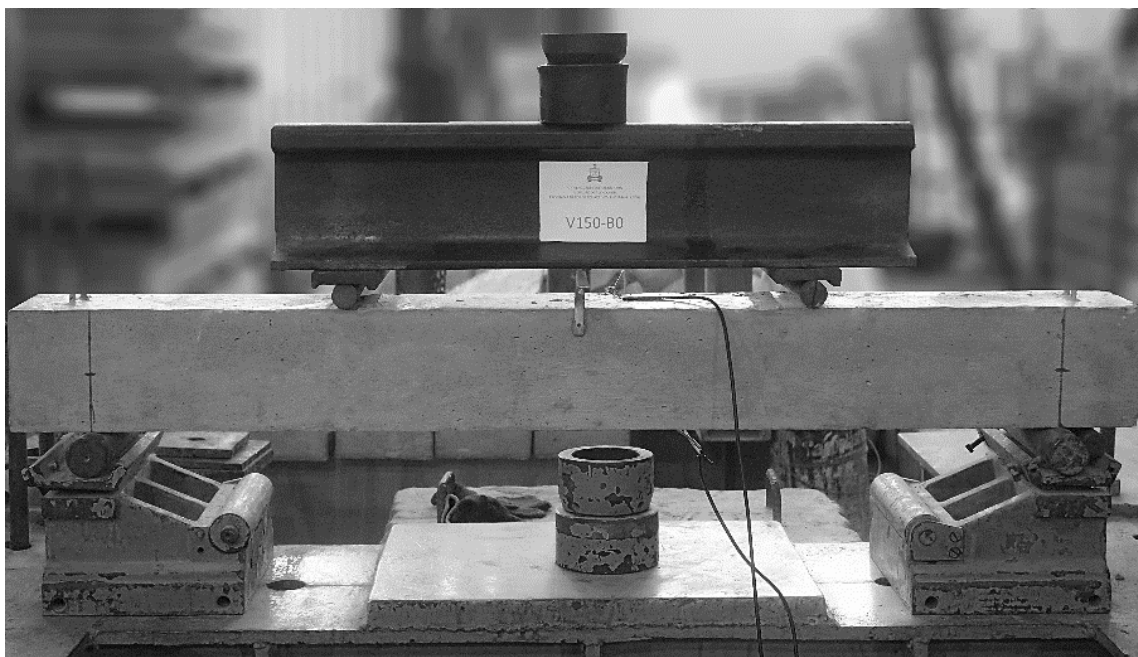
Viga posicionada no pórtico antes do ensaio. Fonte: Autora
